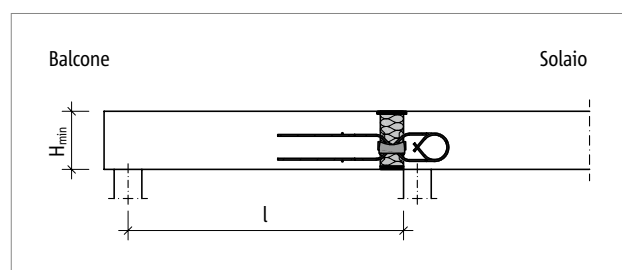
Schöck Isokorb® T tipo QL-VV1: sistema statico
